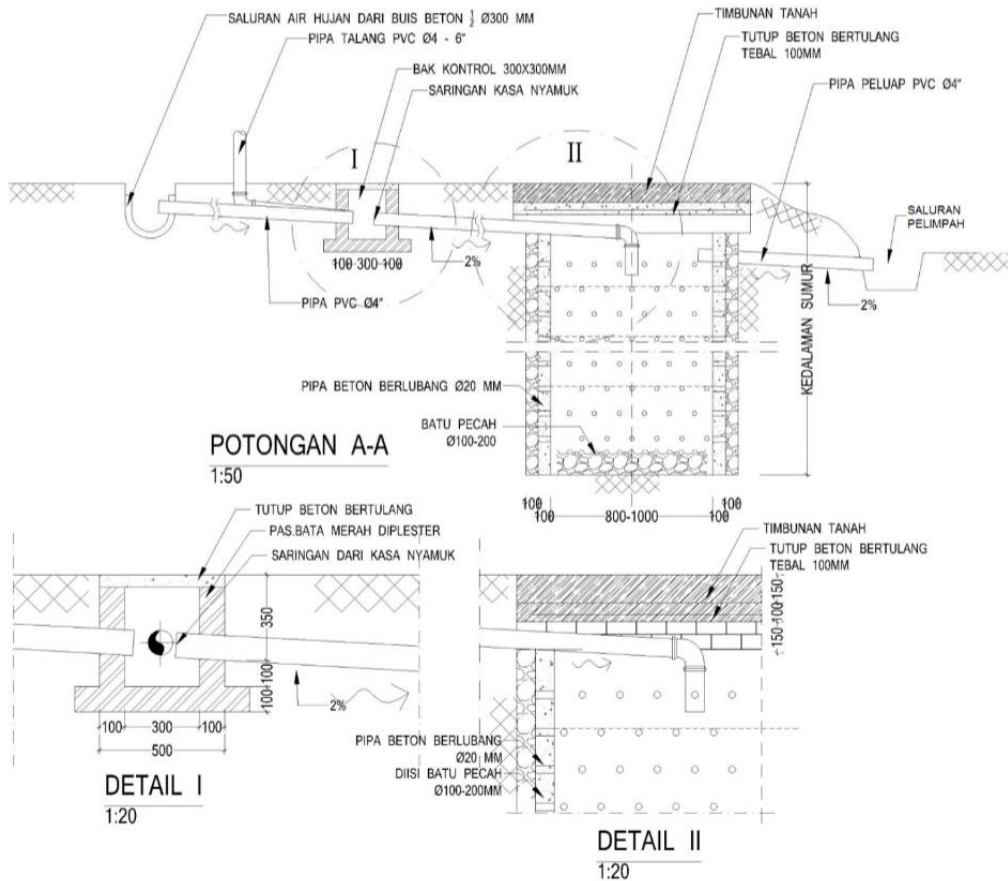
89 Tipe III Sumur resapan air hujan dengan dinding buis beton
